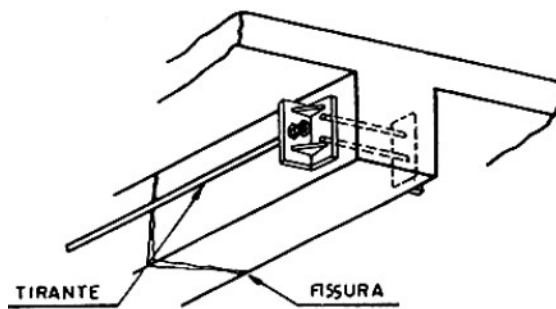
Pré-esforço de uma viga através de tirante roscado [39]
